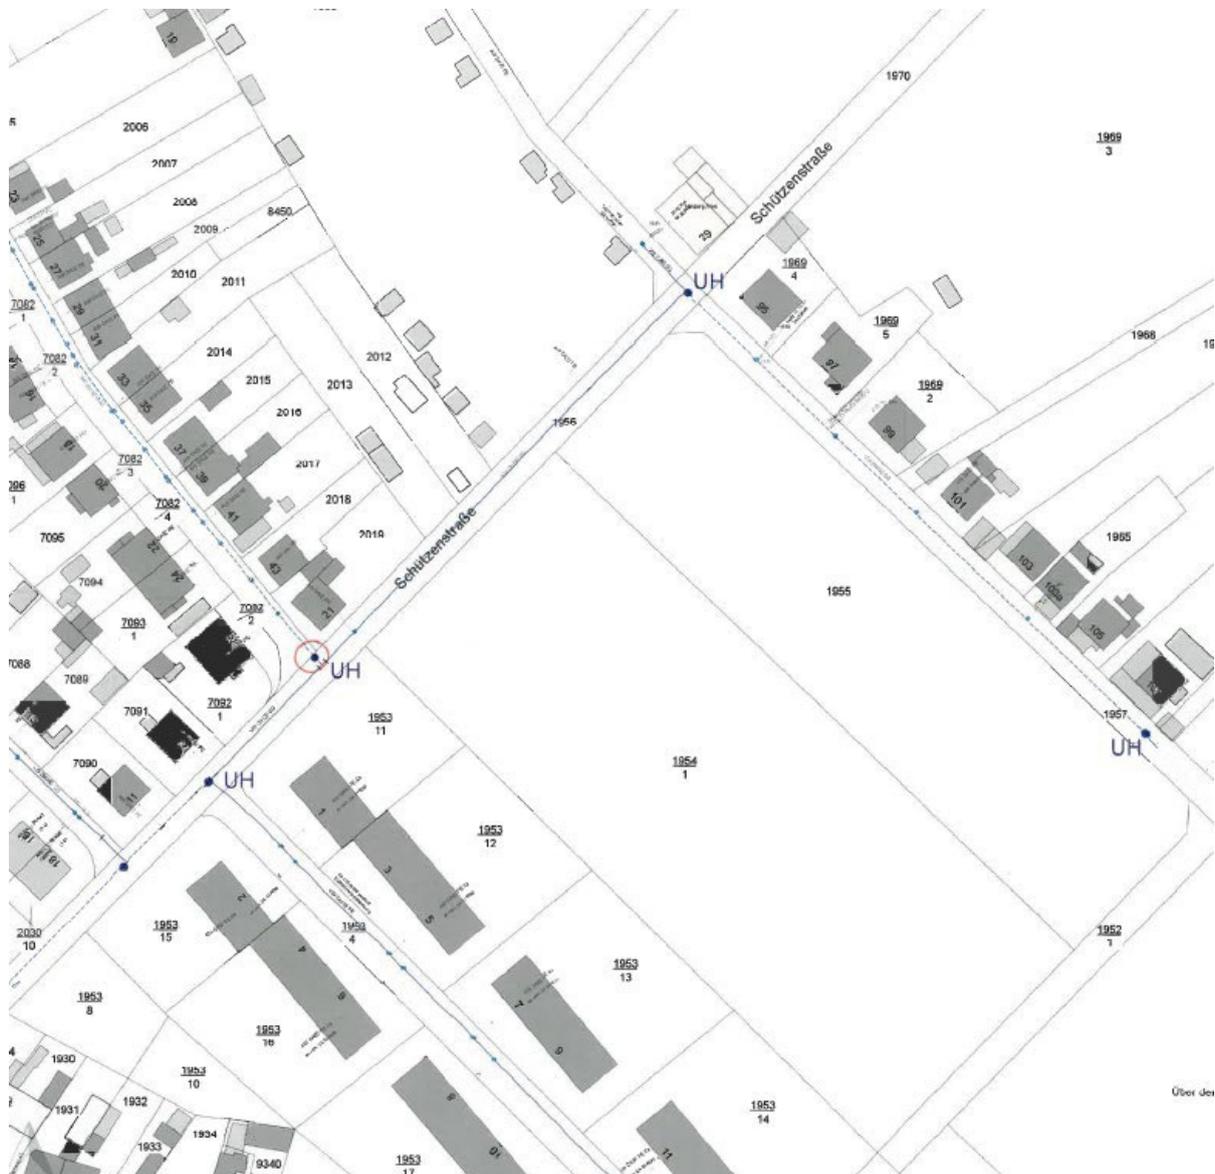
Auszug aus dem Hydrantenlageplan des TAV Eisenach-Erbstromtal – unmaßstäblich
